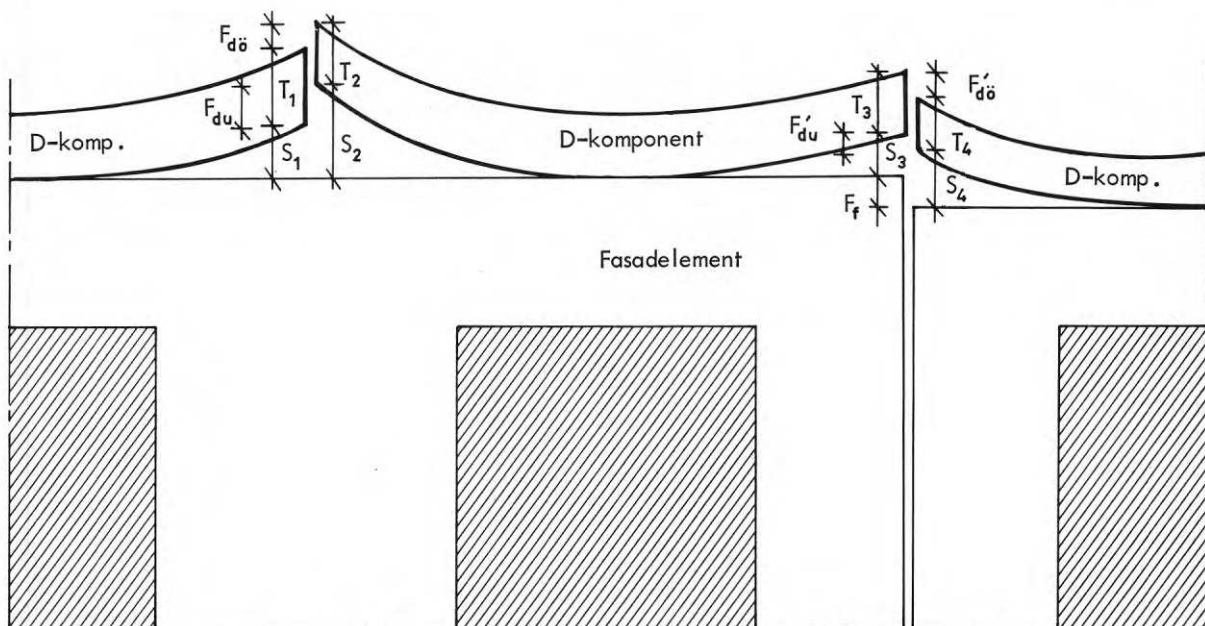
Form, dimensioner och lägesavvikelser som förorsakar höjdskillnader mellan D-komponenter.
